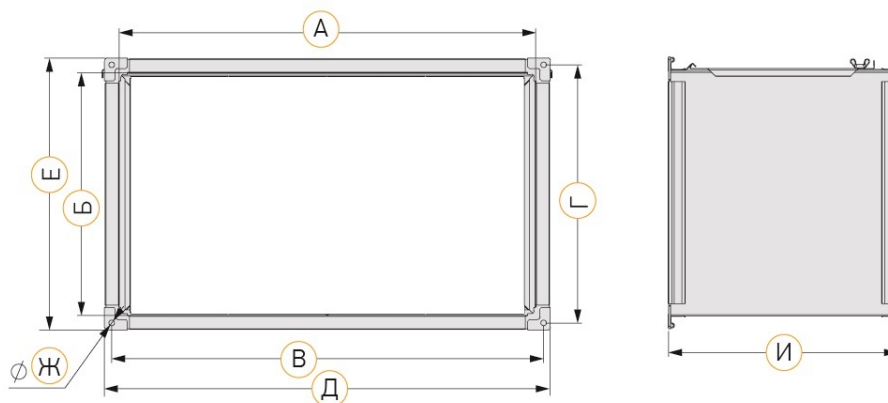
Внешний вид и основные размеры фильтров KPR
